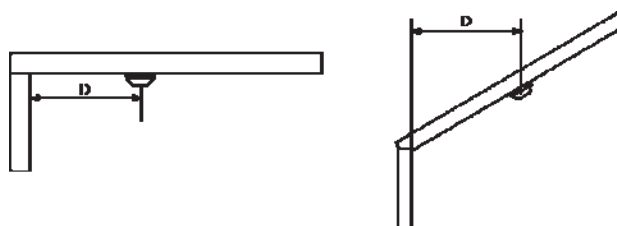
Emplazamiento y separación bajo falsos techos.
